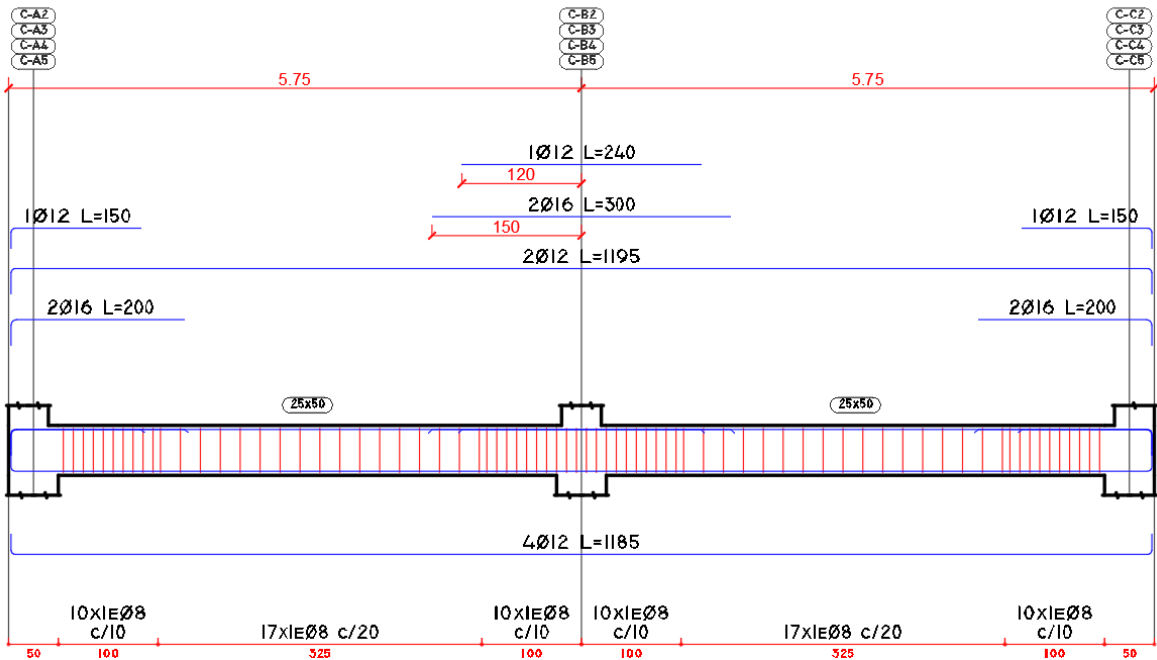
Detalle de Refuerzo Vigas en "X" Piso 5 a 7, Estructura [7N-CS].
